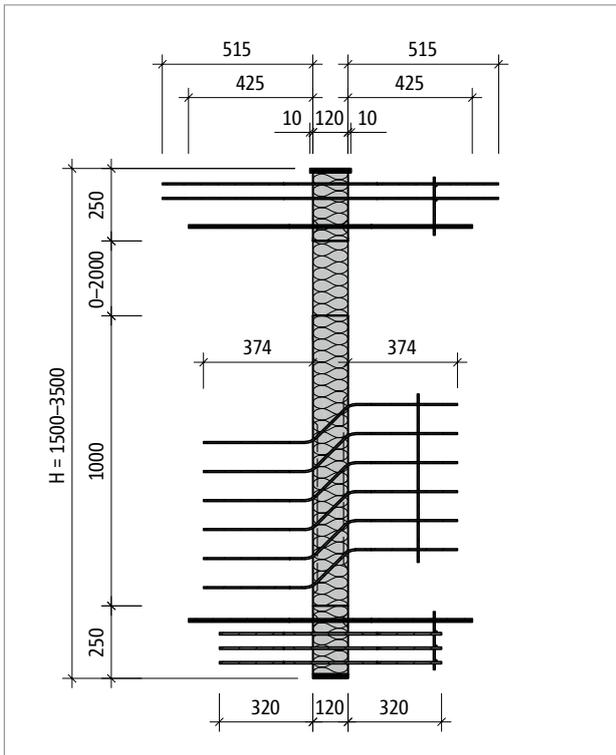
Schöck Isokorb® XT Typ W-M1: Produktschnitt
